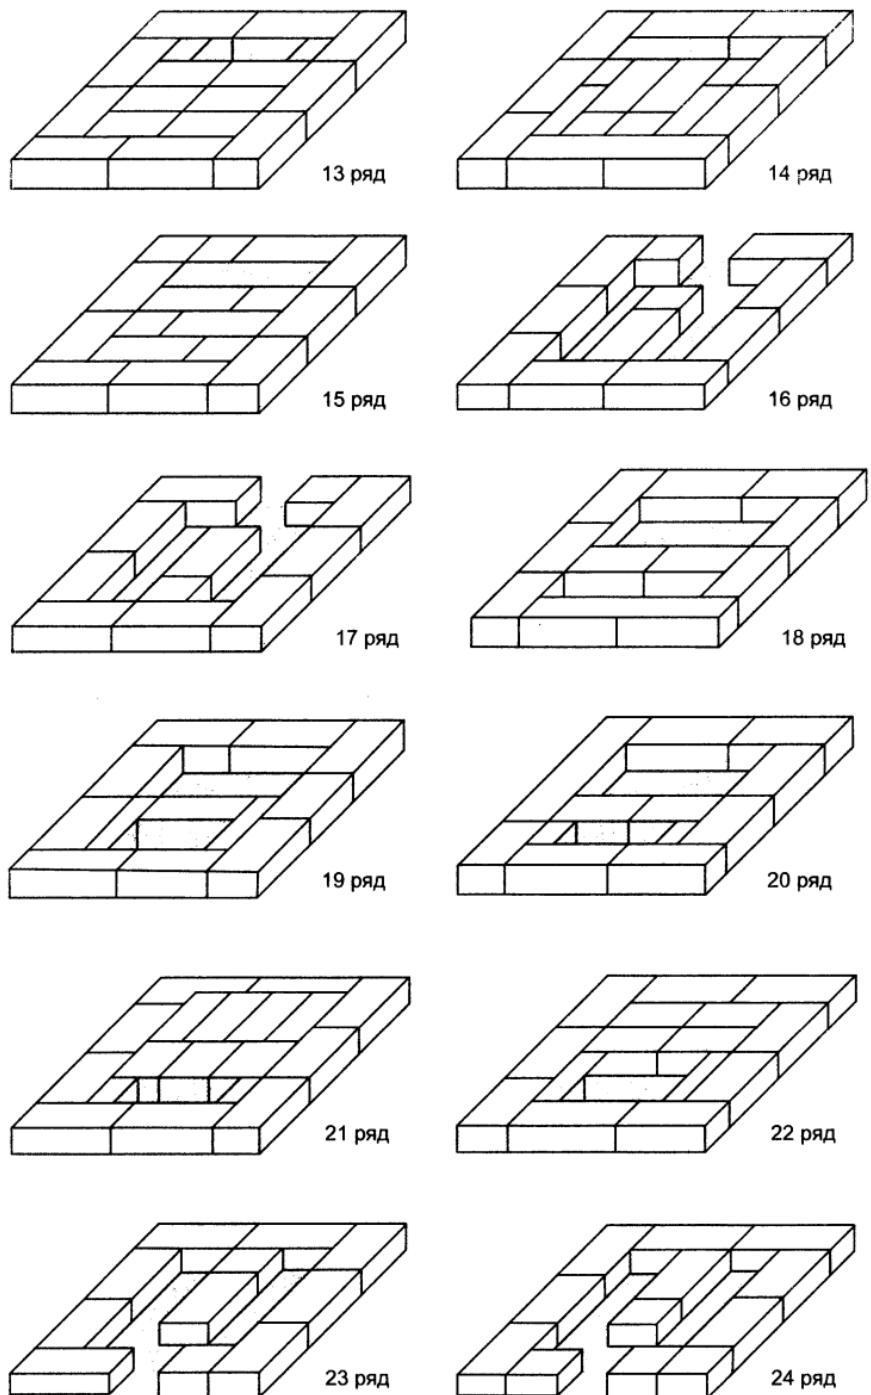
Кладка отопительной печи № 2 (продолжение)
